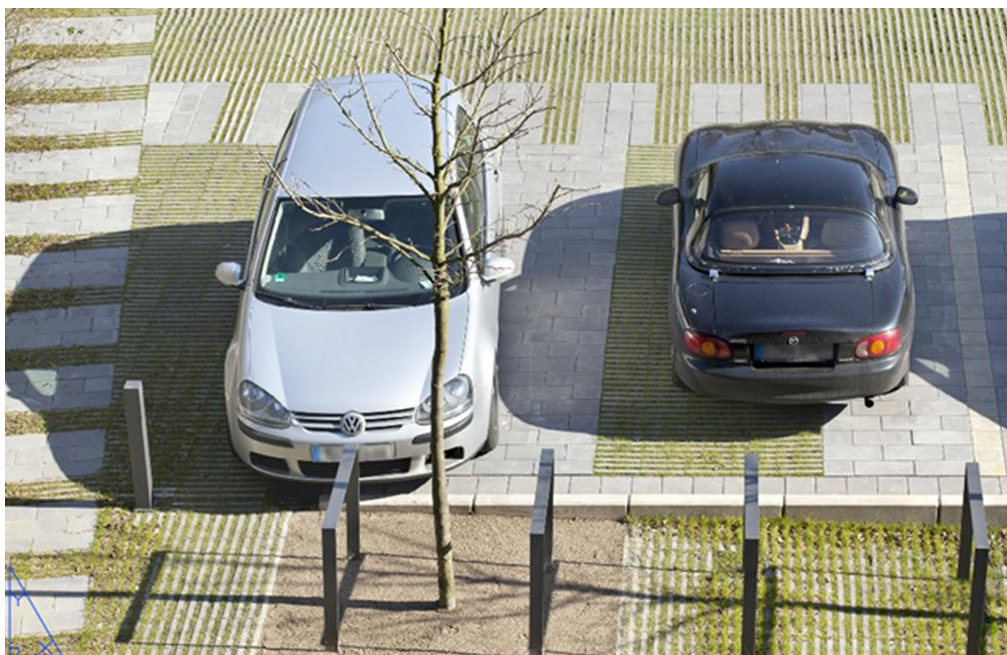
Esempio di pavimentazione con masselli autobloccanti semipermeabili
